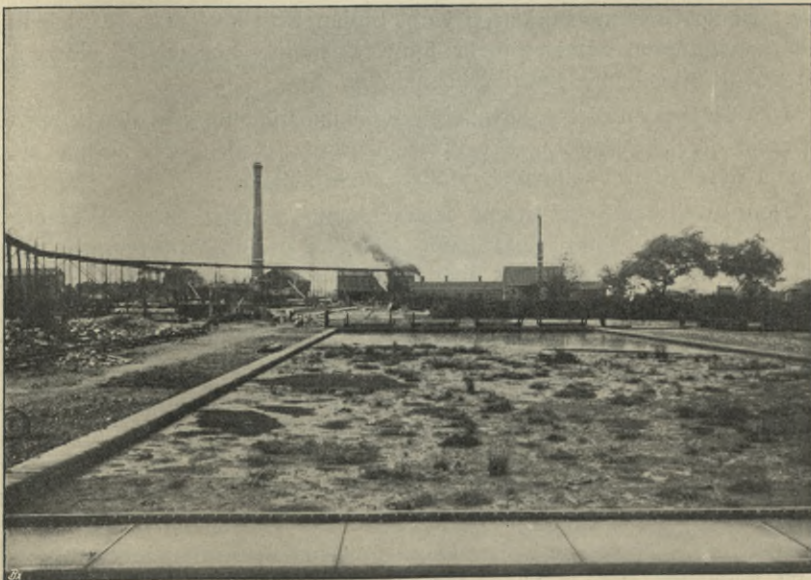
Vollständig zersetzte dünne Schwimmdecke in Birmingham.
